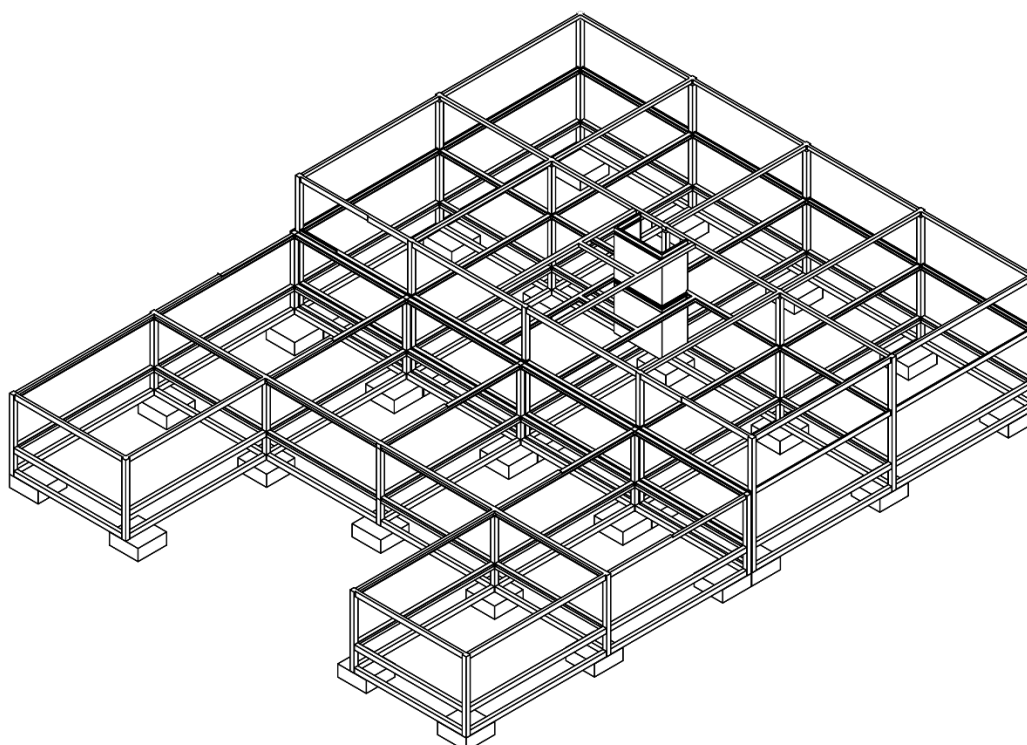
Estructura portante principal de la edificación con sistema mixto y vigas pretensadas.
